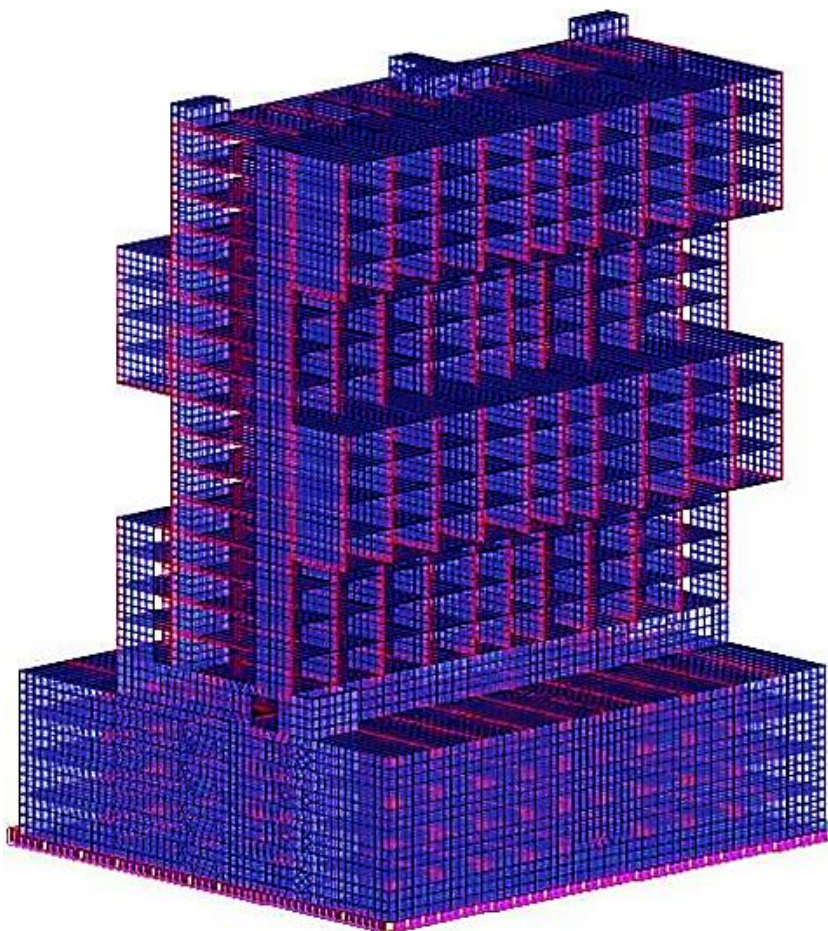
Розрахункова схема будівлі в програмному комплексі
